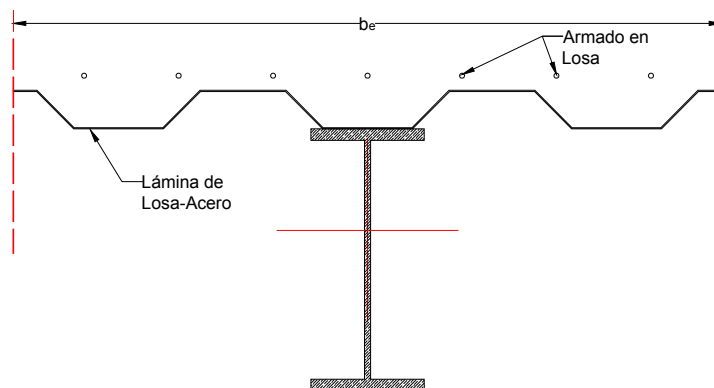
Sección compuesta de Viga. Momento Negativo
